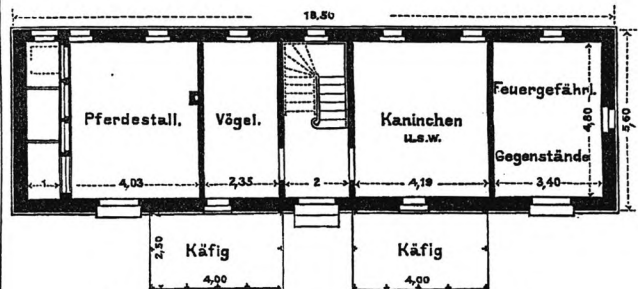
Erdgeschossgrundriß vom Nebengebäude.
